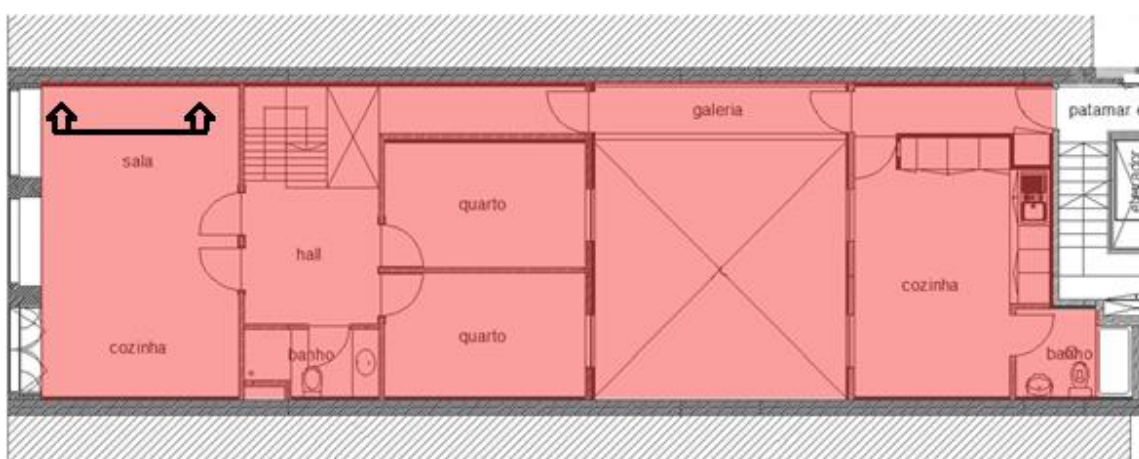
Marcação da zona de corte da laje na planta (Adaptado das peças desenhadas do Edifício do Caso de Estudo)
